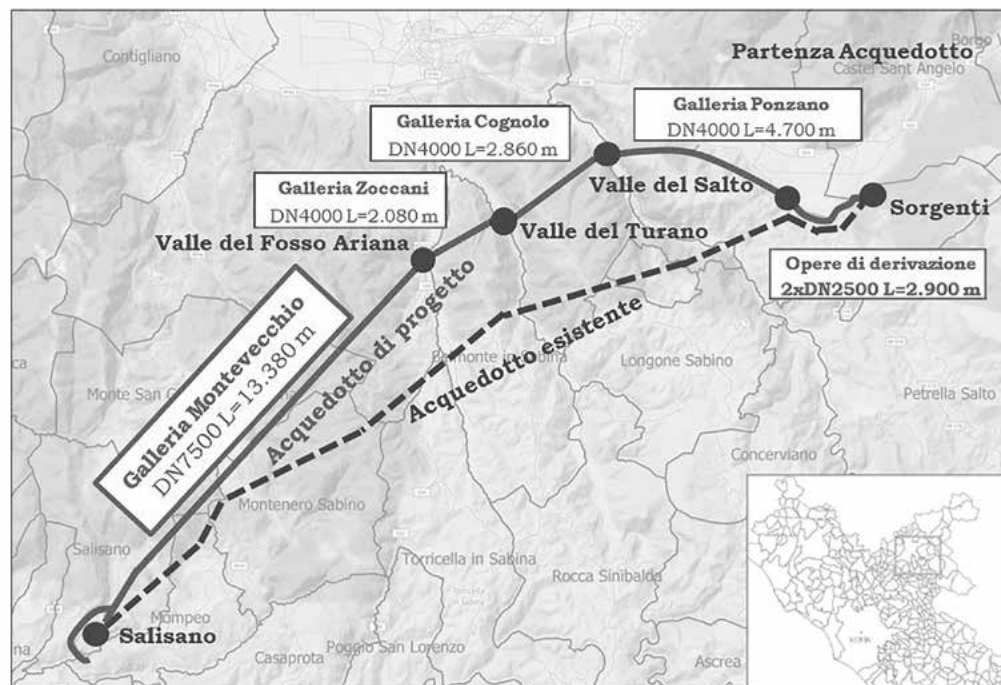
LA PLANIMETRIA DEL NUOVO TRONCO SUPERIORE
